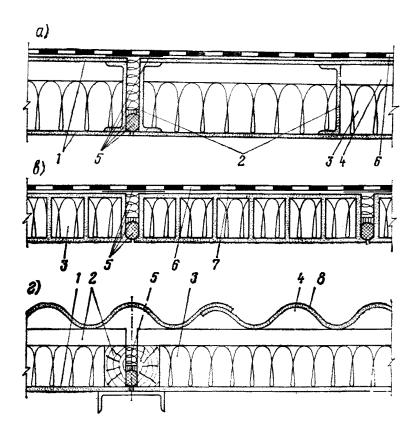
Схемы типов покрытий из асбестоцементных плит
